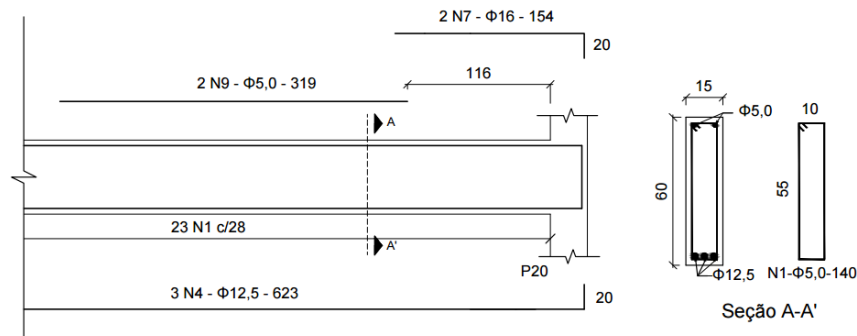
Detalhe das armaduras de um trecho da viga mais solicitada.
